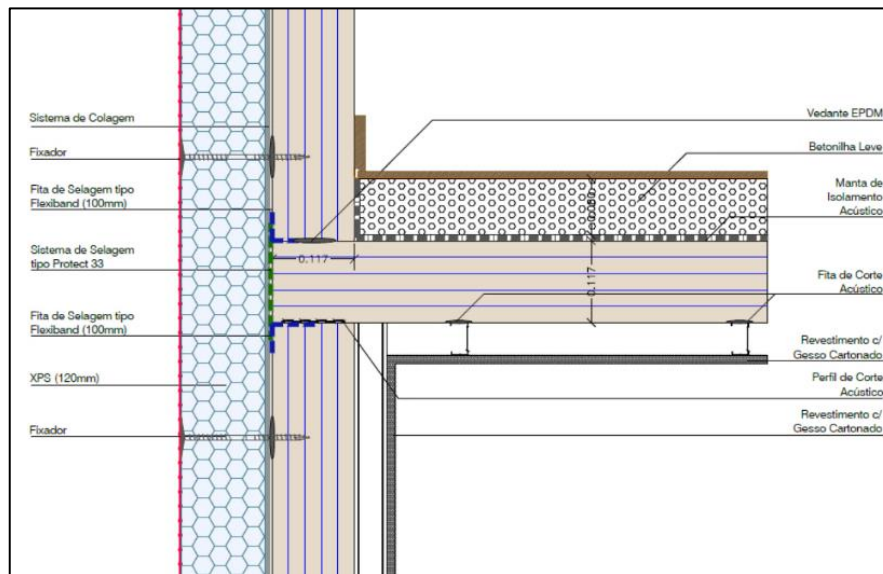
Pormenor construtivo de uma construção em CLT [18]
